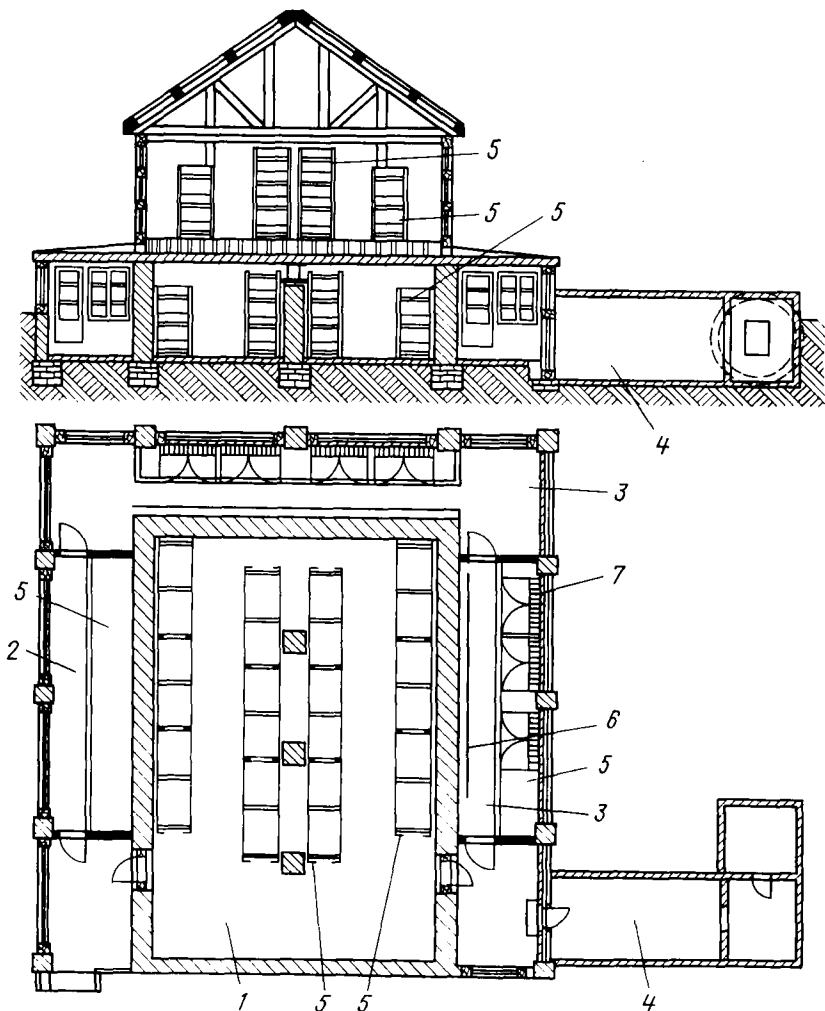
Разрез камеры ускоренных испытаний и план ее нижнего этажа:
